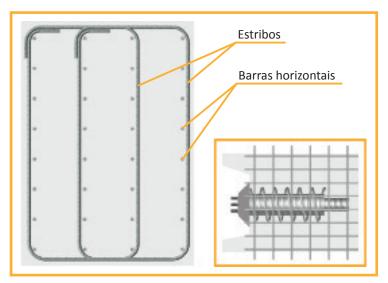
Seção transversal de armadura de fendilhamento. No detalhe, seção longitudinal da mesma armadura.
